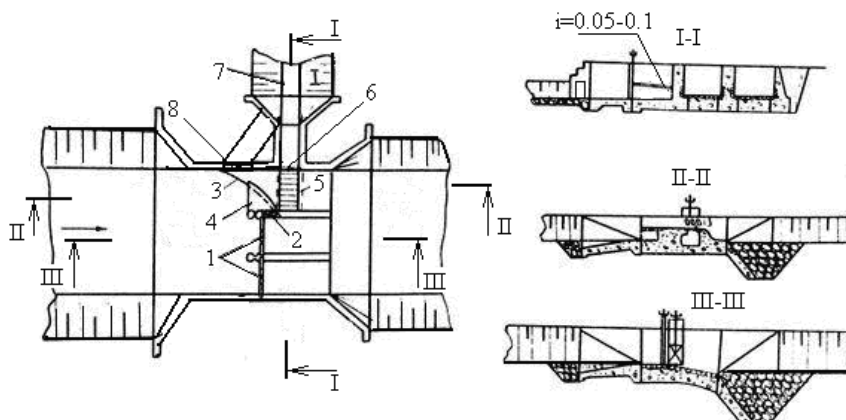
Усовершенствованное водозаборное сооружение решетчатого типа: 1 – щитовой сброс; 2 – промывник; 3 – криволинейный порог; 4 – съемная железобетонная полка; 5 – водоприемная галерея, перекрываемая решеткой; 6 – водоприемник; 7 – деривационный канал; 8 – отверстие зимнего водоотбора
